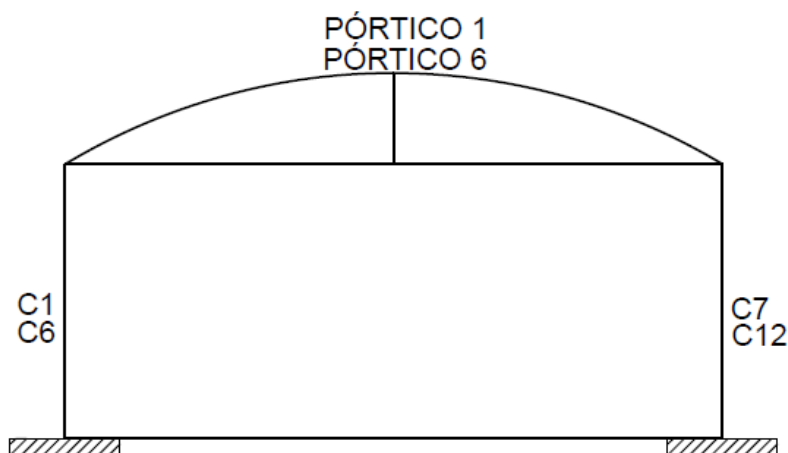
Figura que evidencia las llamadas “Columnas Extremas”
